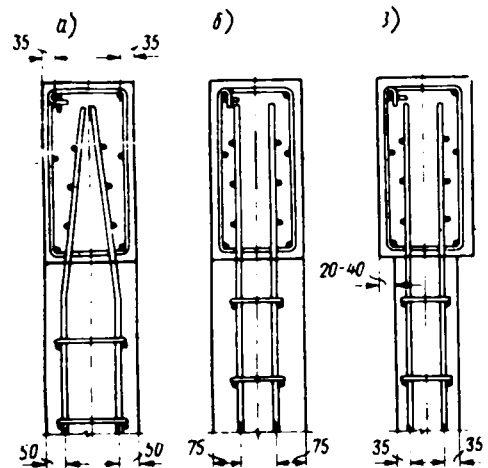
Примеры решения поясов и решетки ферм одинаковой и разной ширины
